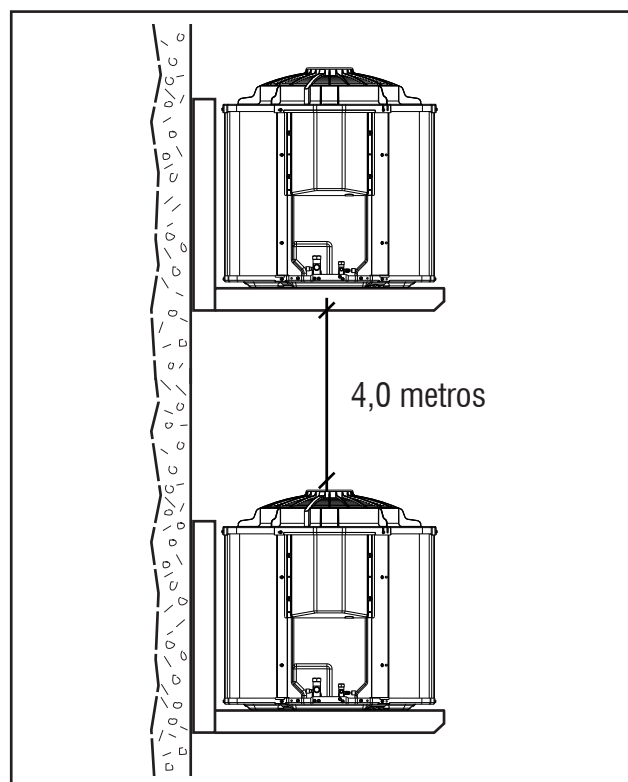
INSTAL. COM MÃO-FRANCESA
